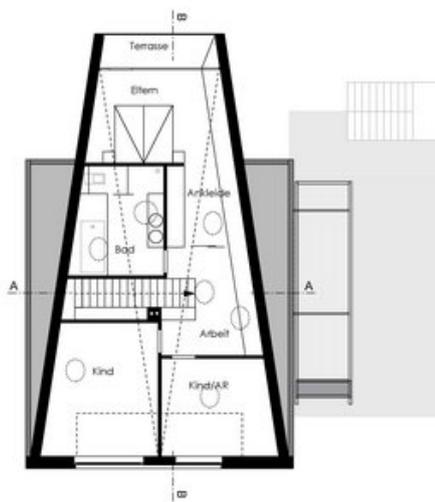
Grundrisse des Dachgeschosses
